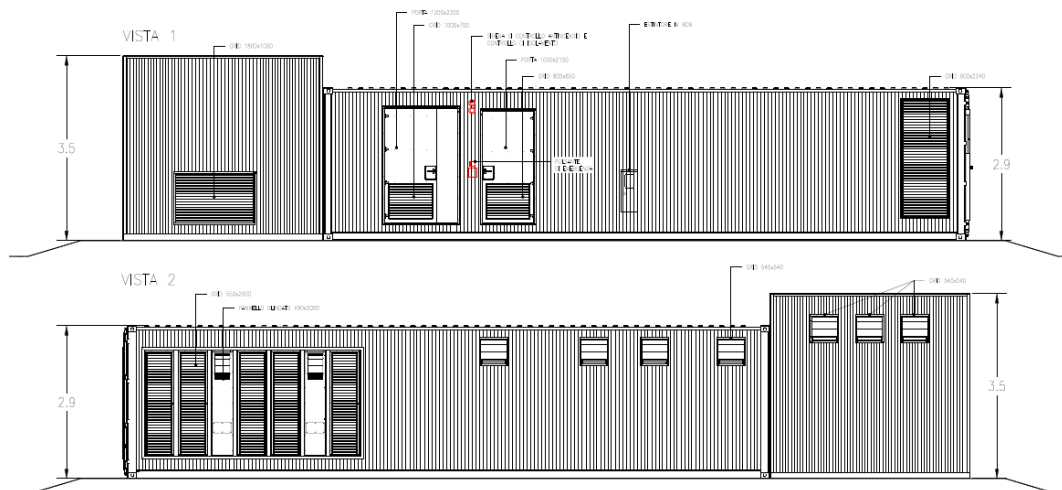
Layout cabina elettrica – Prospetti - (Power Station)
